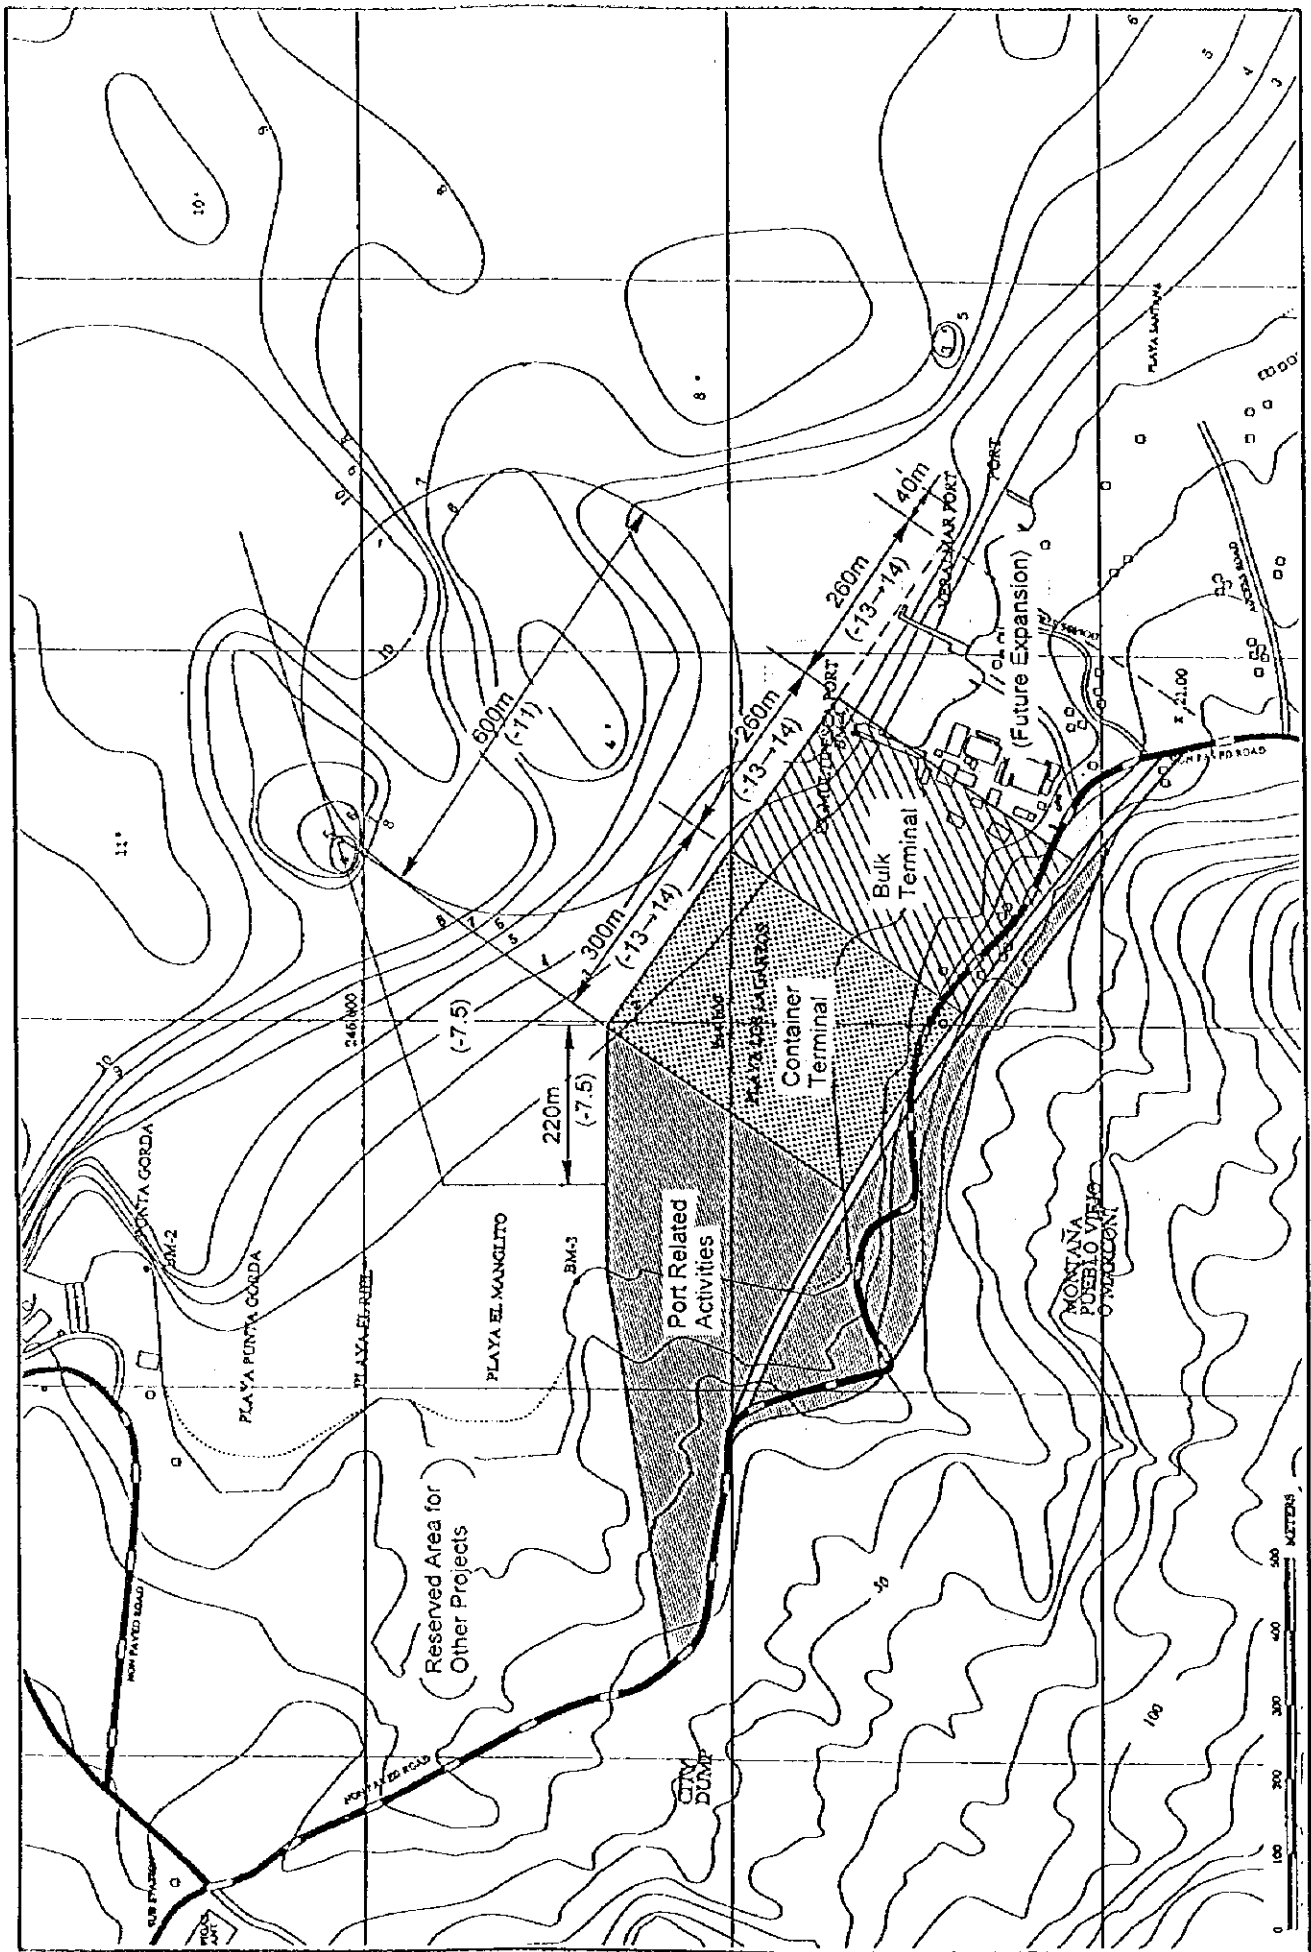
Plano de Disposición de la Alternativa B-3
